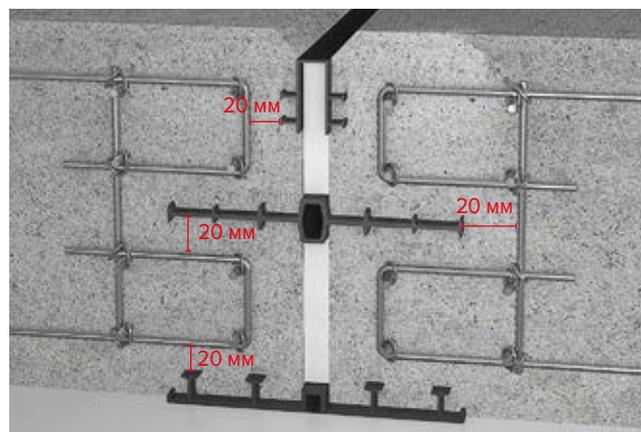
Расстояние от края гидрошпонки до арматурного каркаса
